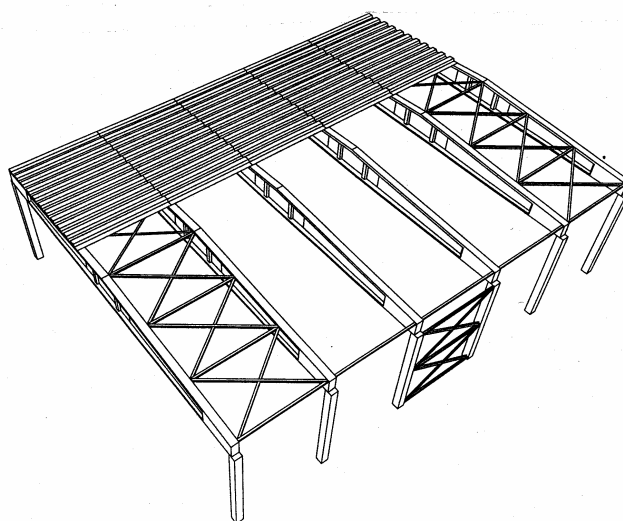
Diagonais de contraventamento para estrutura da cobertura e/ou fachada
